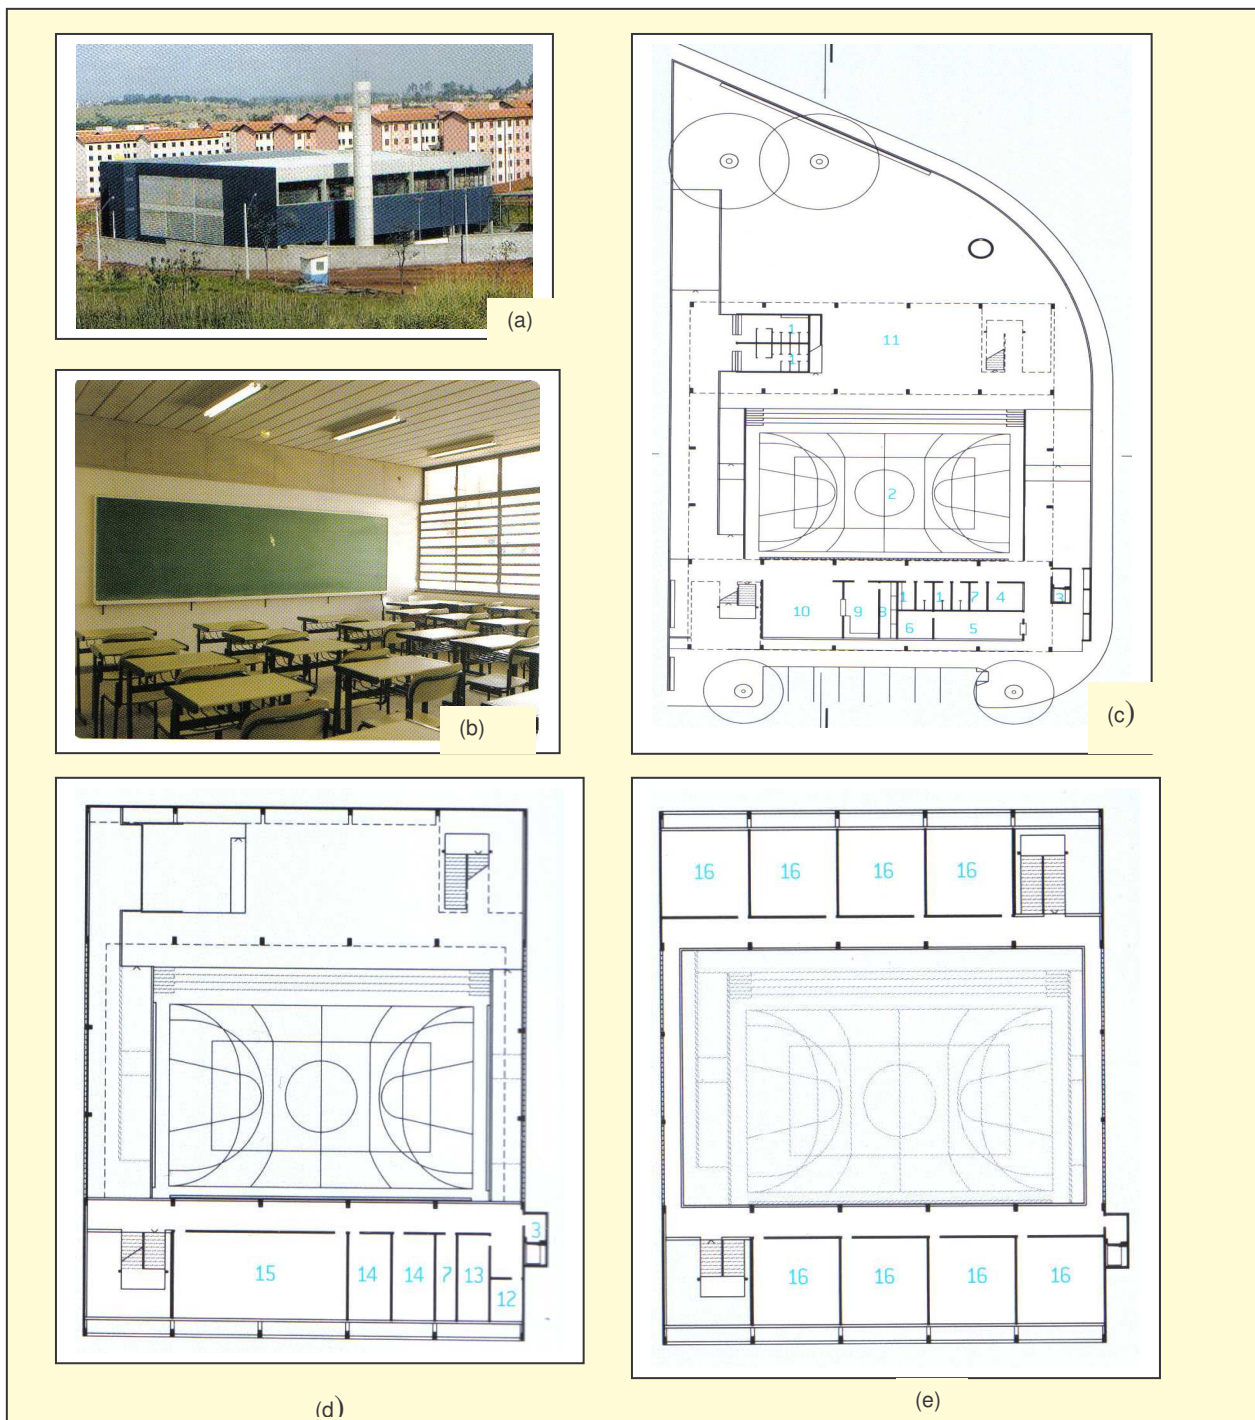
EE Conjunto Habitacional Campinas F1, projeto do escritório MMBB Arquitetos, para a cidade de Campinas, SP. (a): vista da escola e seu entorno; (b): vista interna da uma das salas de aula; (c): planta baixa da implantação/térreo; (d): planta baixa do 1.º pavimento; (e): planta baixa do 2.º pavimento.
